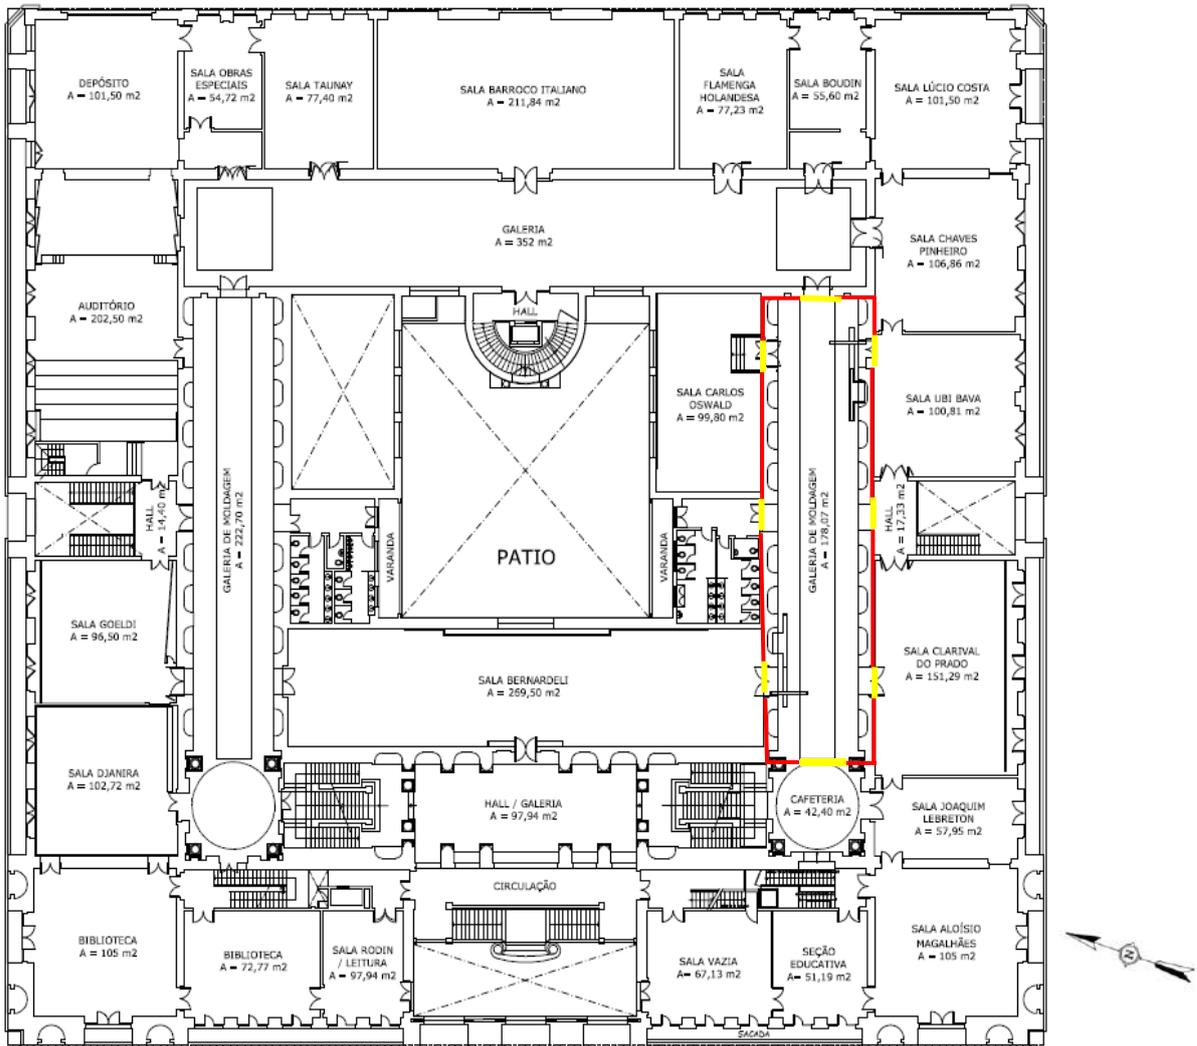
Planta baixa do 2º pavimento do MNBA com indicação da Galeria de Moldagens I, das salas e Galeria (aberturas).
